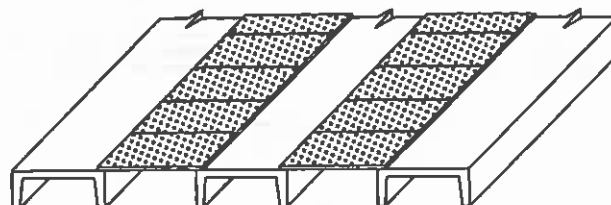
Faixas de clarabóias em painéis U ou TT (2)
